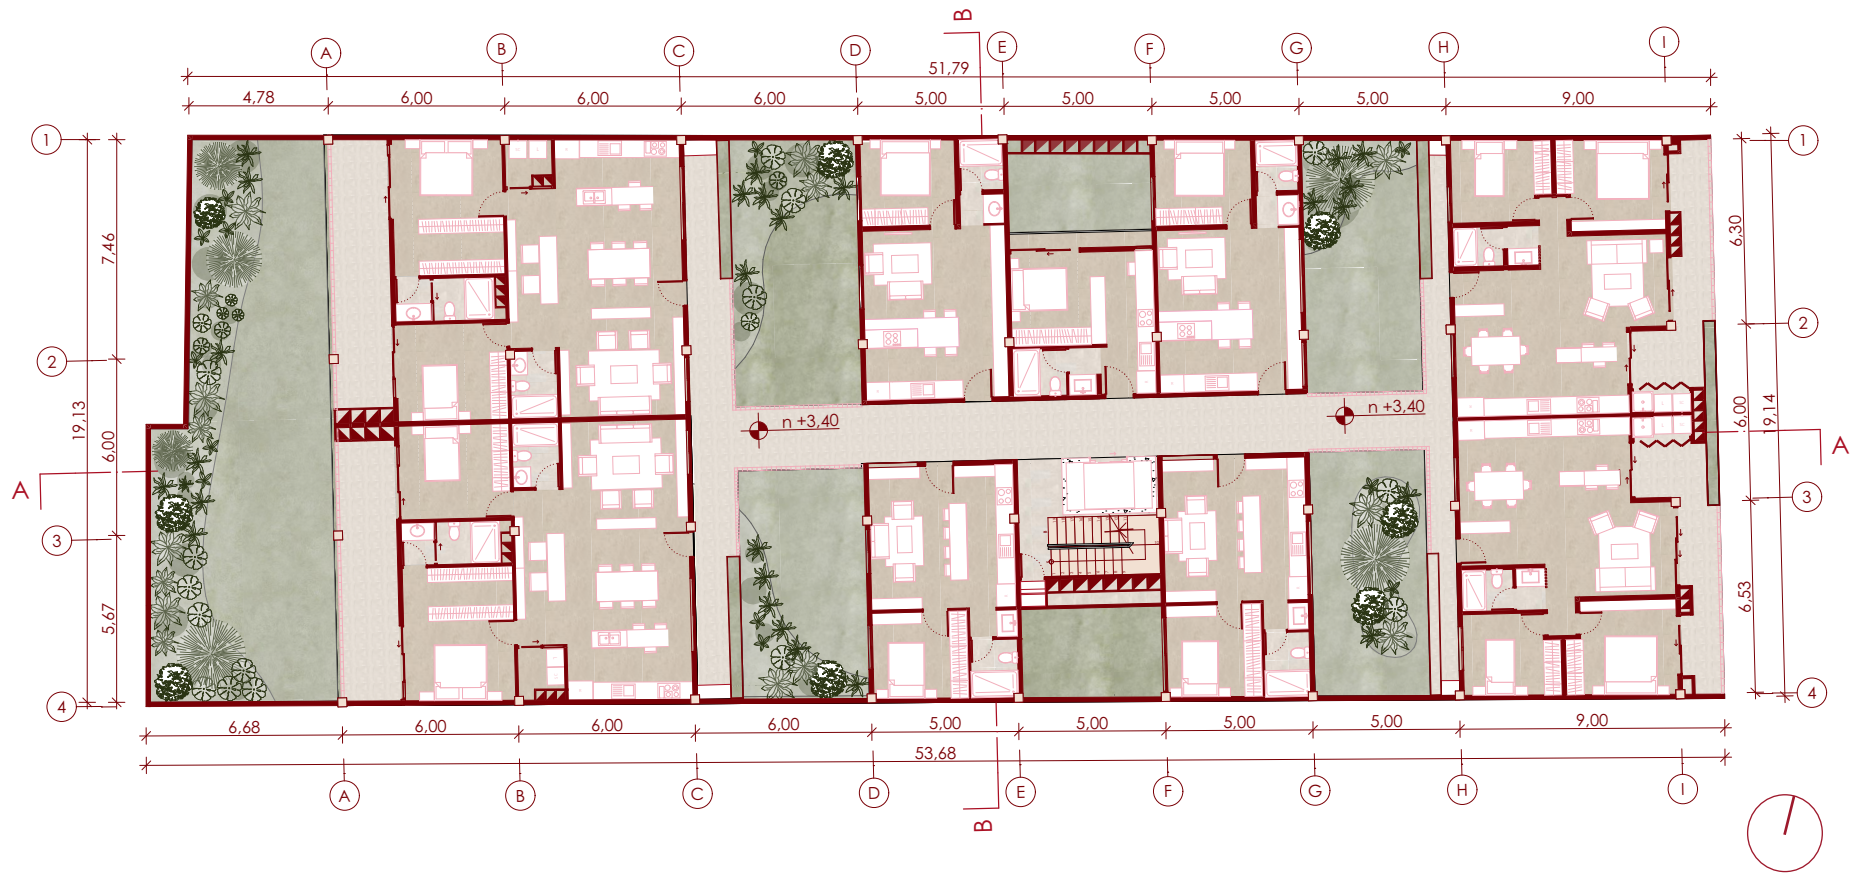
Planta tipo del proyecto. Nota. Elaboración propia.
